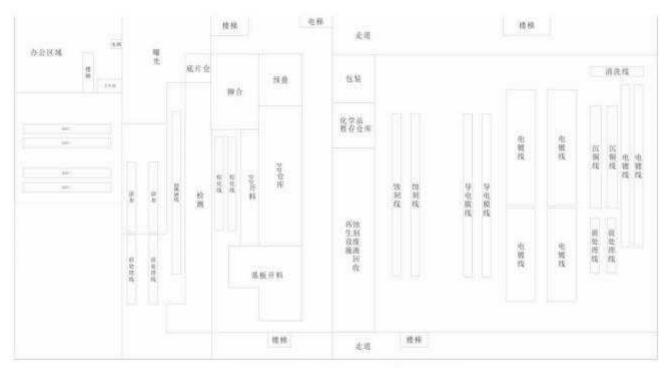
项目厂房 2.3.4 三层平面布置图
